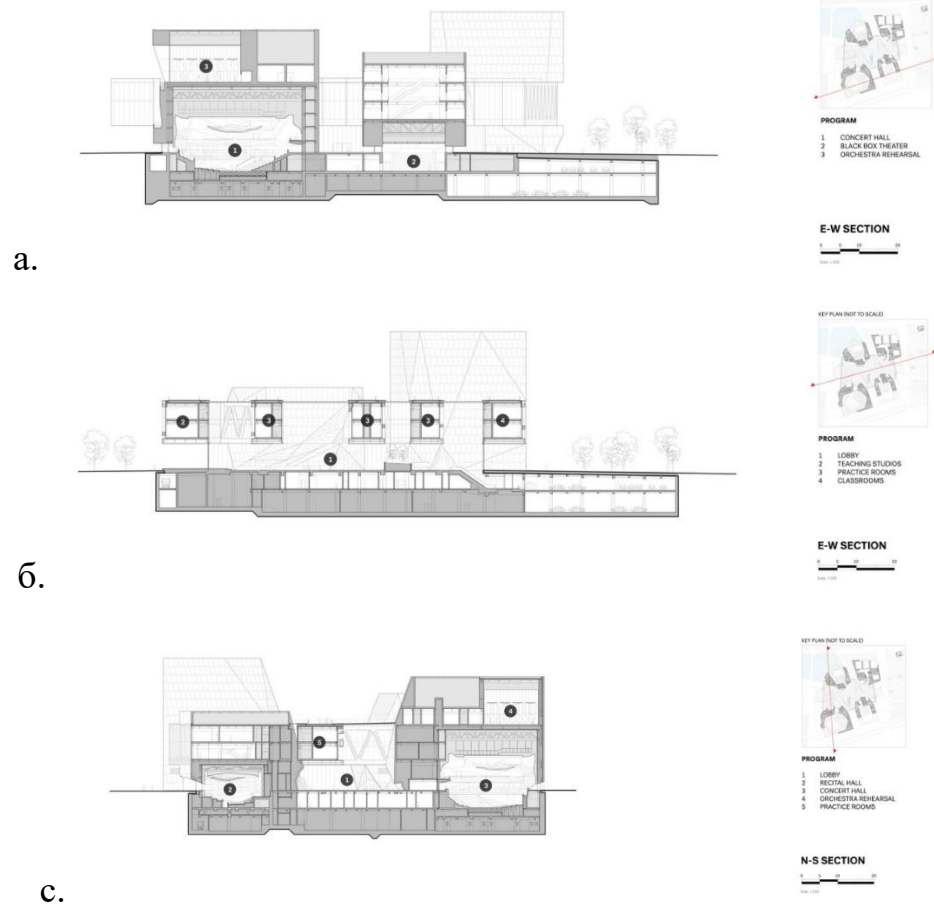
а – Повздовжній розріз 1 E-W section; б – Повздовжній розріз 2 E-W section; с – Поперечний розріз N-S section [22]
